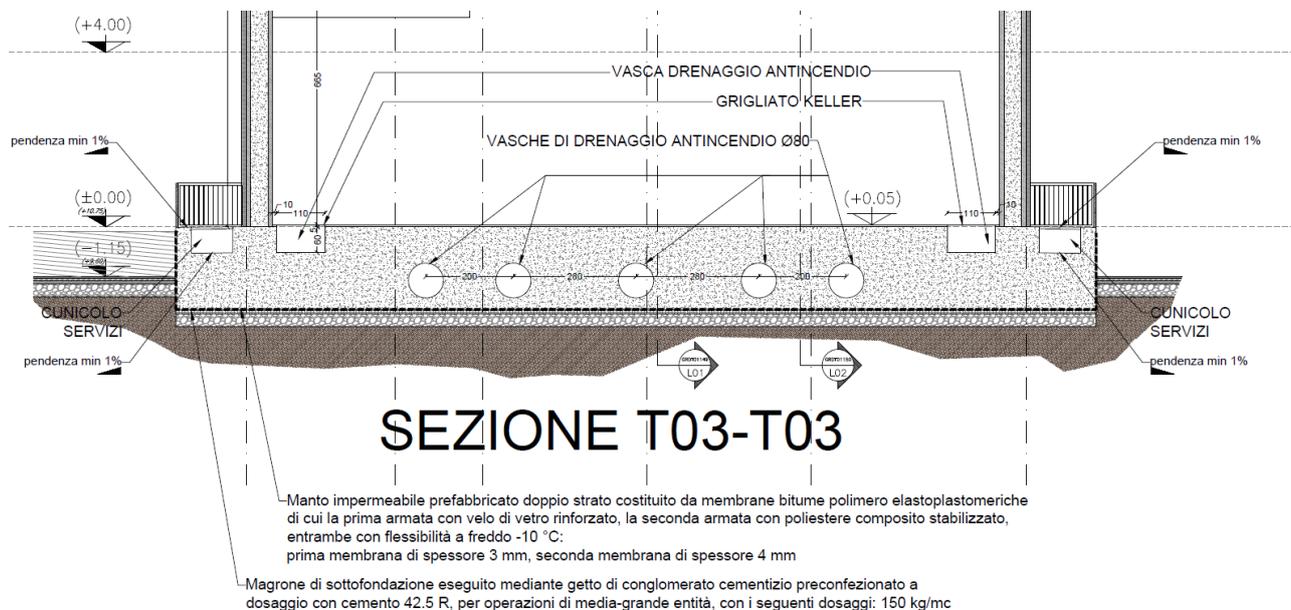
Particolare di dettaglio in sezione della platea di fondazione superficiale
